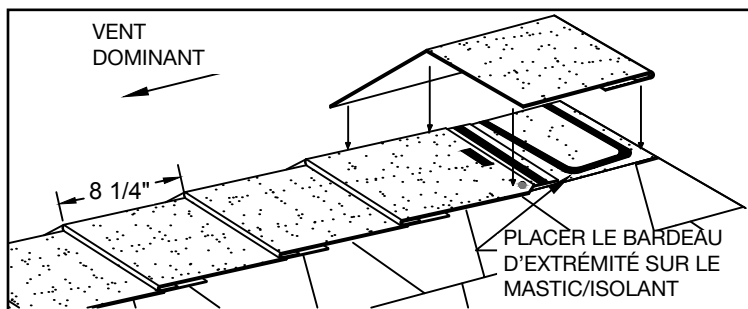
Découpe d'un bardeau EZ-Ridge® en embout
